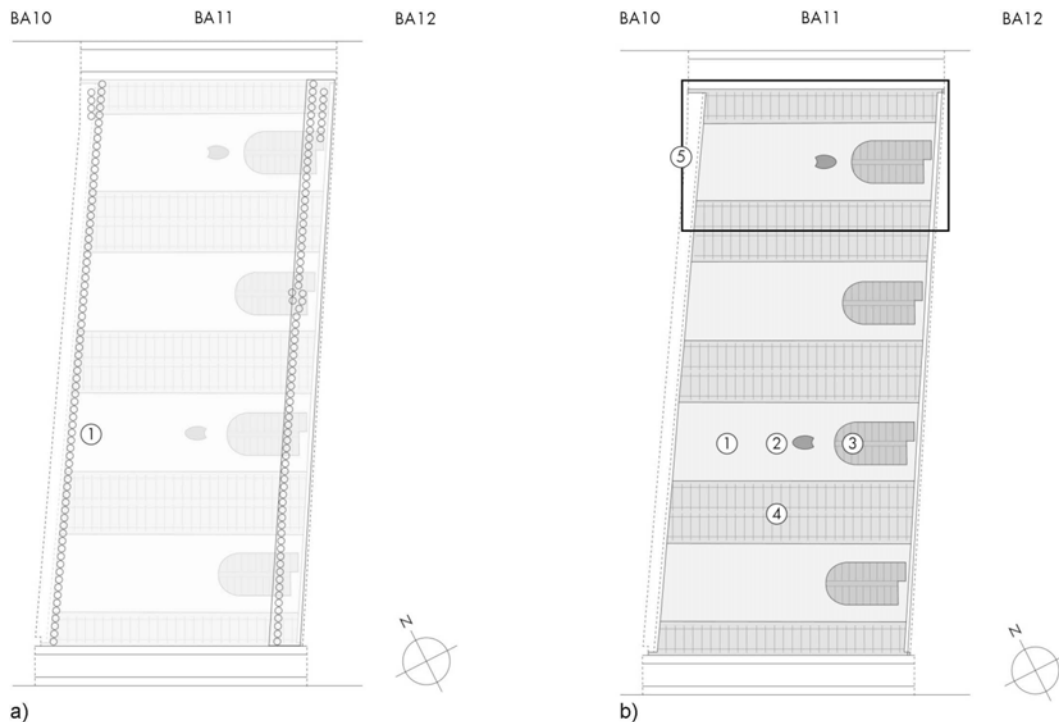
Grundriss der S-Bahn-Querung: a) Pfahlgründung – 1 Bohrpfahlgründung, b) Brückenbauwerk – 1 Bahnsteig, 2 Kelchstütze (60 MN im GZT), 3 Treppena-
